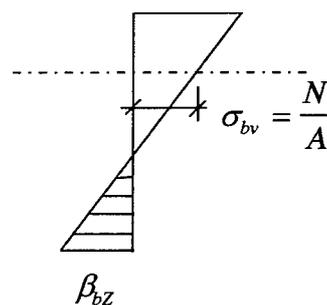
Ermittlung des Zugkeils zur Bestimmung der Bewehrung zur Rißbreitenbeschränkung
